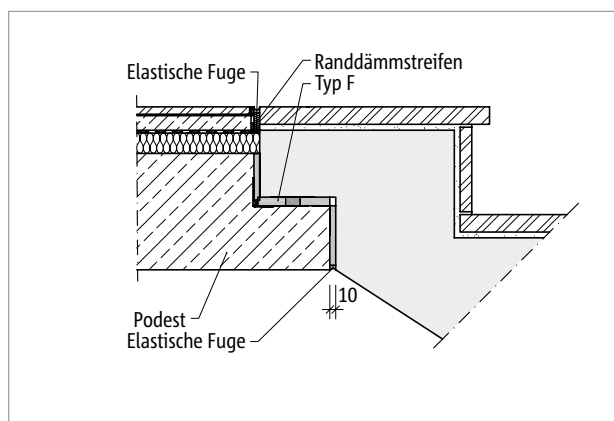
Schöck Tronsole® Typ F: Brandschutzausführung
